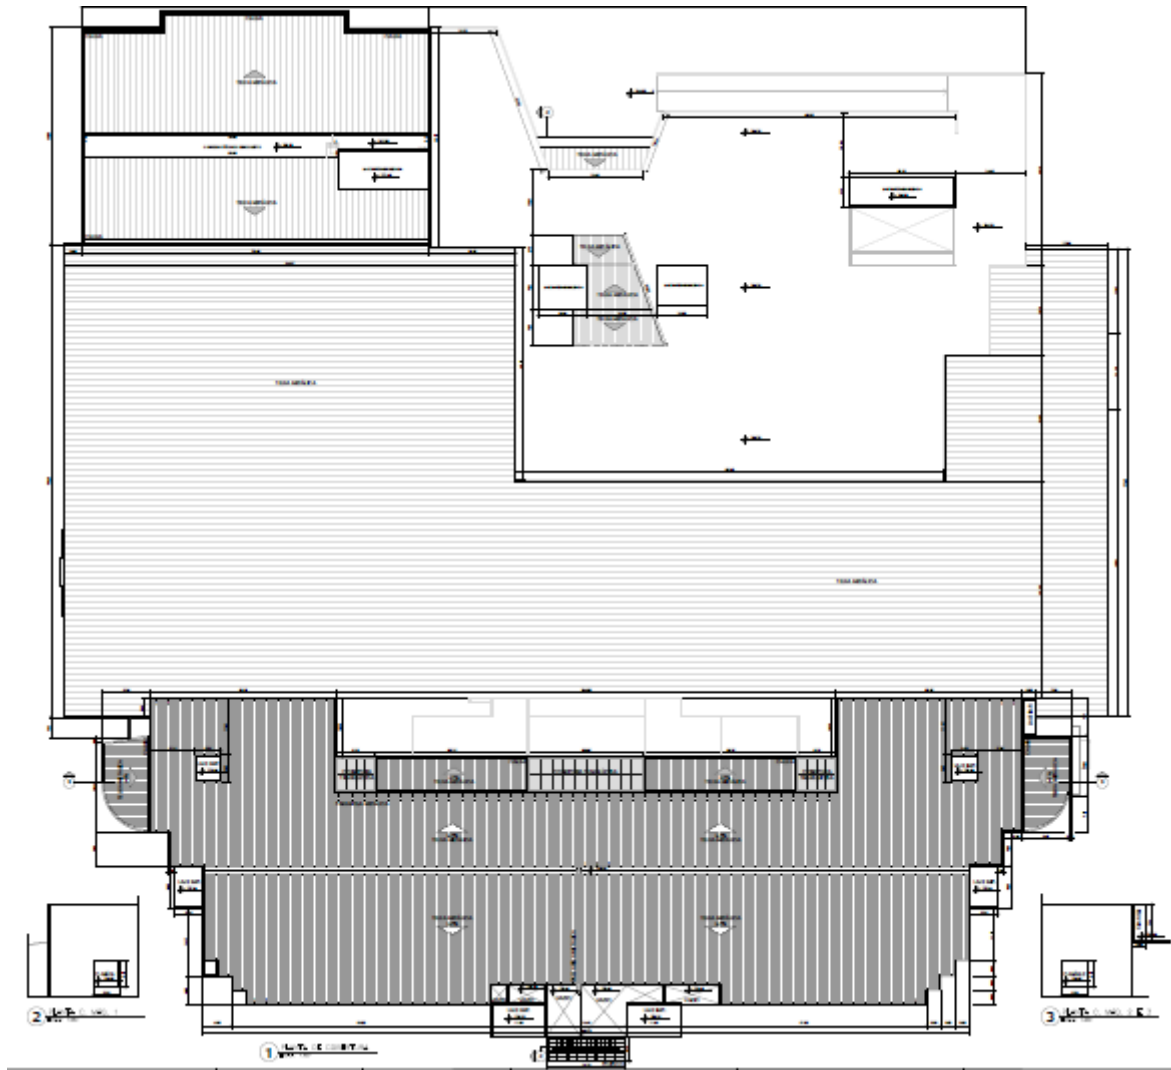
Planta de Cobertura. Fonte: Engexpor.
